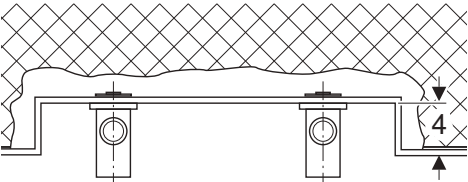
Dimensões de instalação para montagem interior com deslocamento da placa de montagem Geberit
